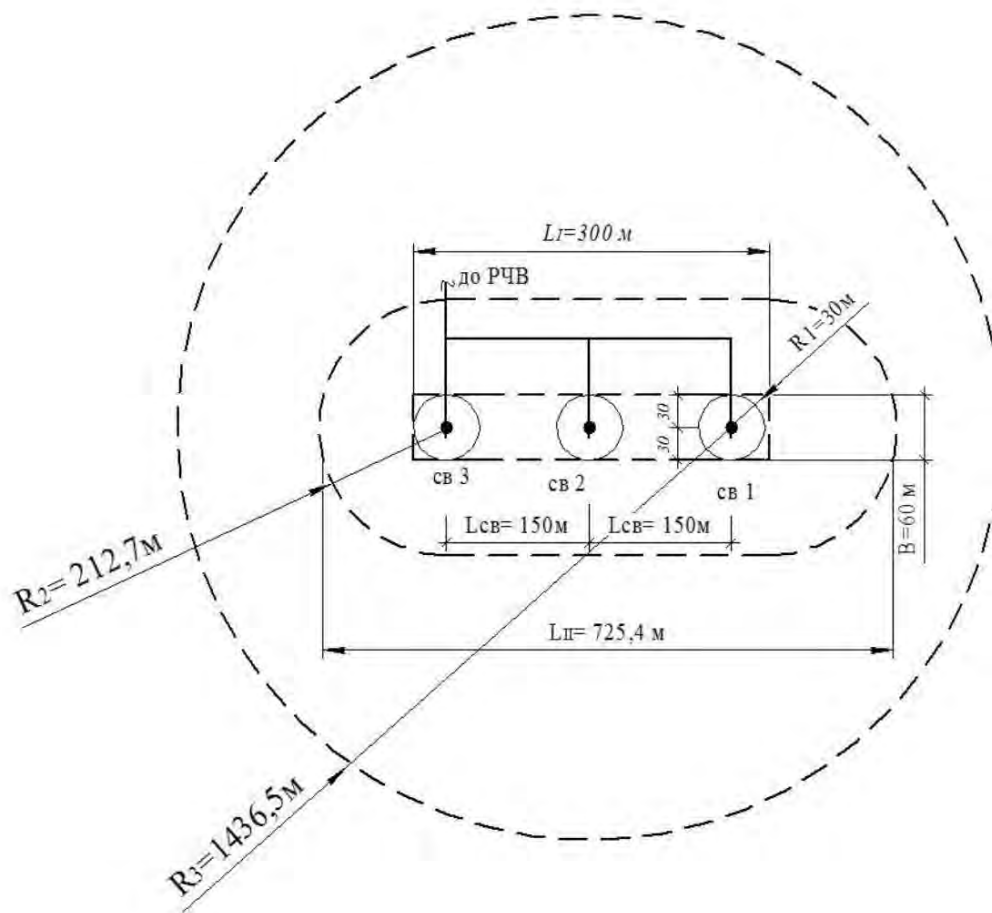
Схема поясів ЗСО підземного джерела та водозабірних споруд (після реконструкції)
